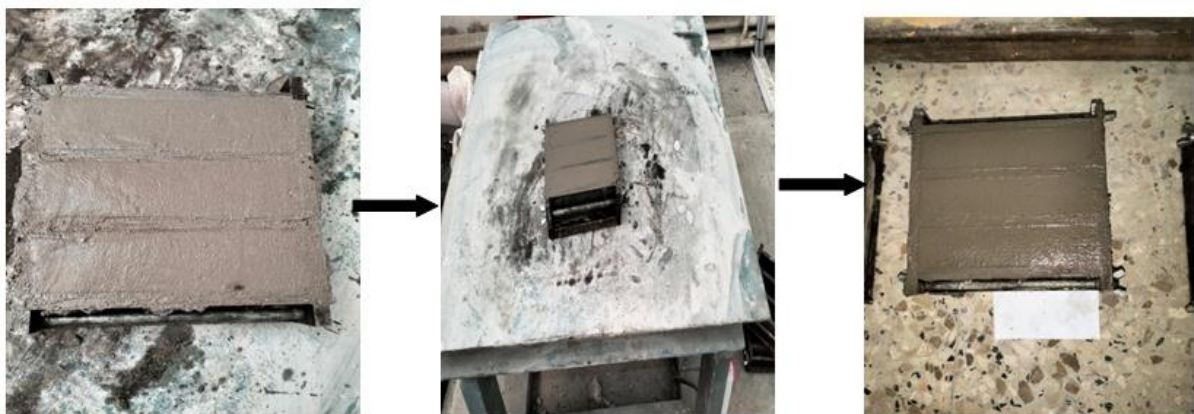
Mise en œuvre et moulage des éprouvettes.
